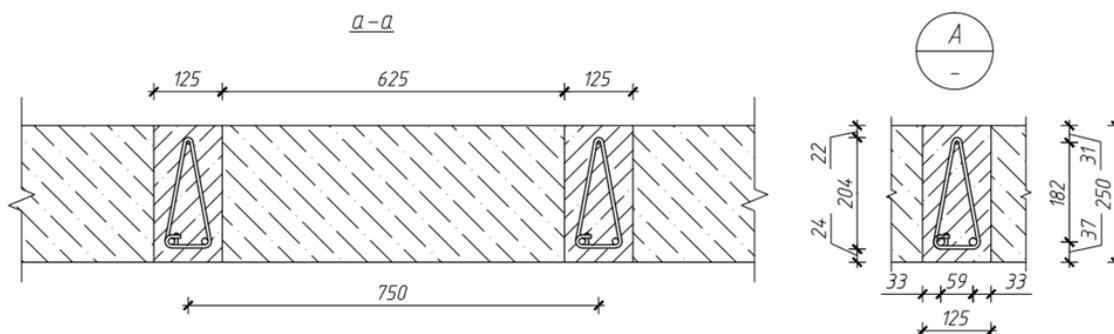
1 вариант устройства сборно-монолитного перекрытия.
